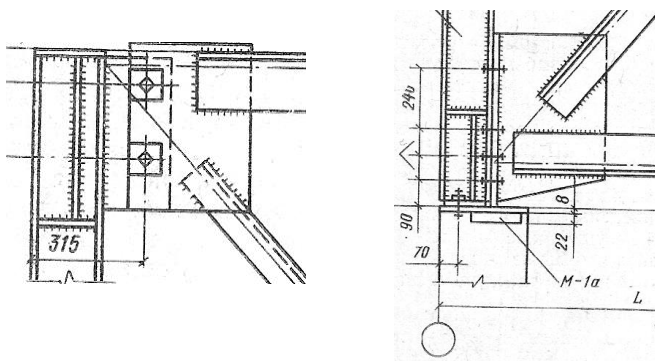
Опираие стальной фермы на железобетонную колонну
